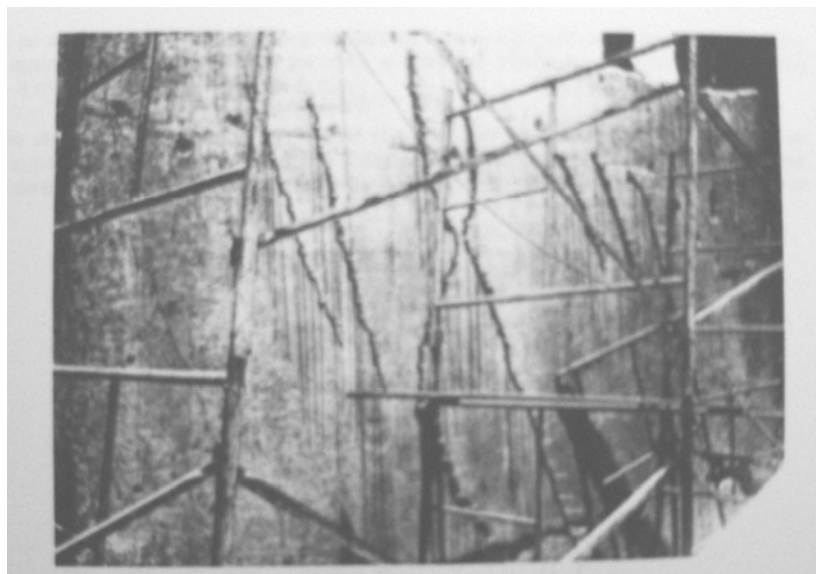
Instalação de tubos plásticos para injeção de resina nas fissuras, em viga alta de concreto armado (parcialmente encoberta por andaime tubular). (Fonte: THOMAZ)
